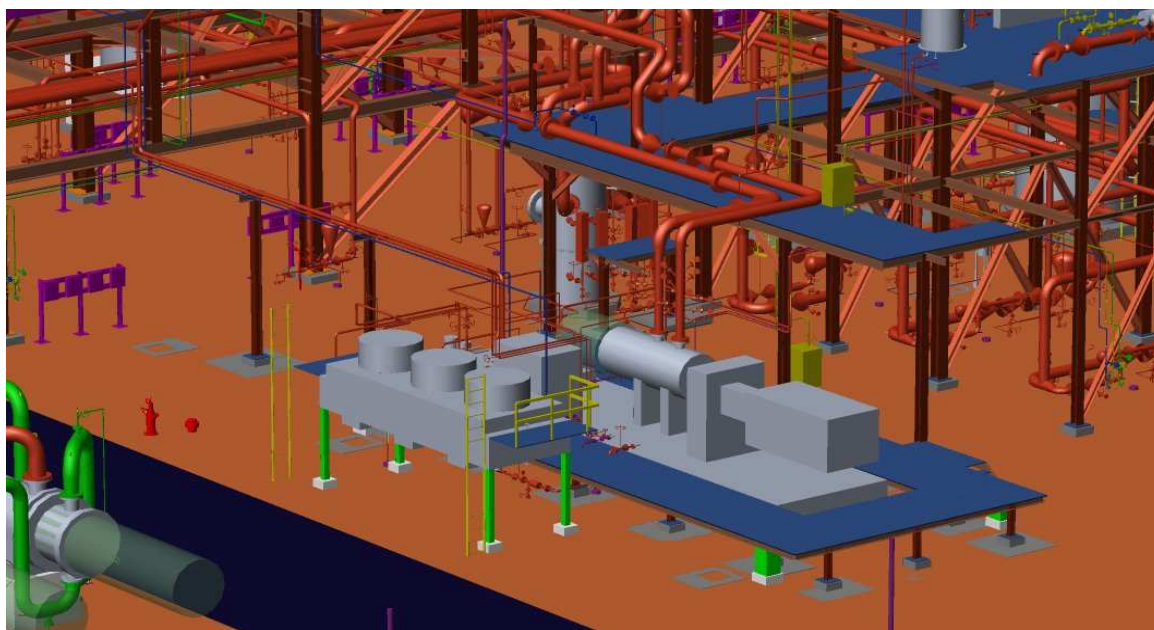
Disposición de Tuberías Alrededor de Compresores Centrífugos- Elevación
